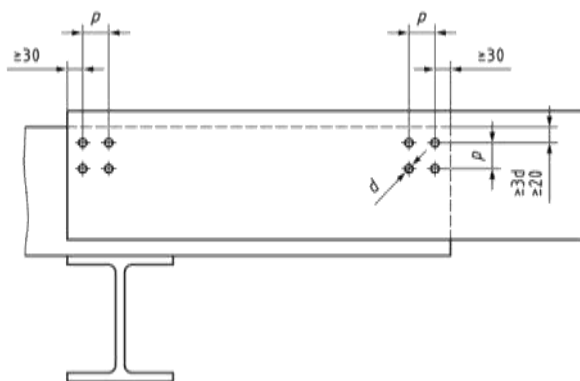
Disposizione dei bulloni per un collegamento staticamente efficace.
